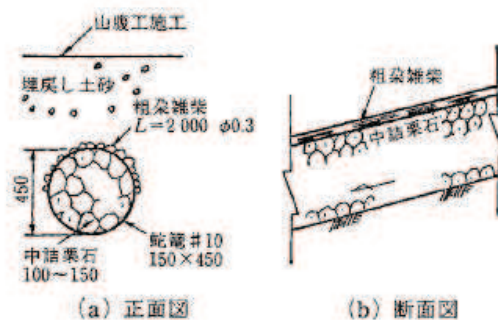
蛇籠暗渠工の例(単位: mm)
